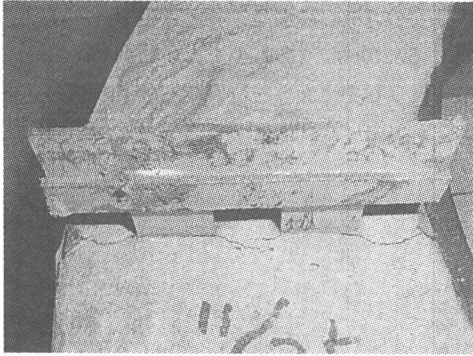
ひび割れ発生状況 (Cシリーズ)
